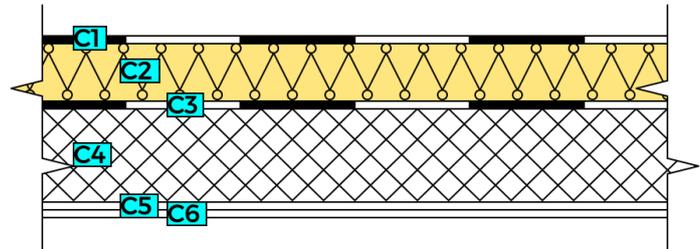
Toiture en dalle béton Toiture Plate 06 issue du site web TOTEM
